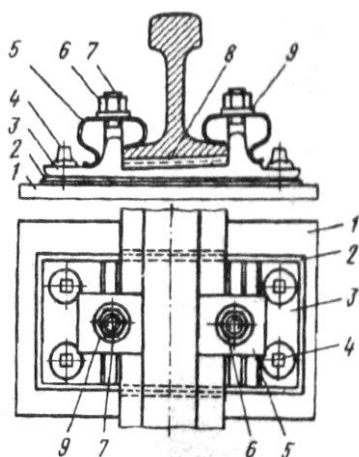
Конструкція скріплення КДП на дерев'яних шпалах: 1 – дерев'яна шпала; 2 – прокладка під підкладку; 3 – металева підкладка; 4 – шуруп; 5 – пружна пластинчатая клема; 6 – гайка; 7 – клемний болт; 8 – підрейкова прокладка; 9 – плоска шайба
